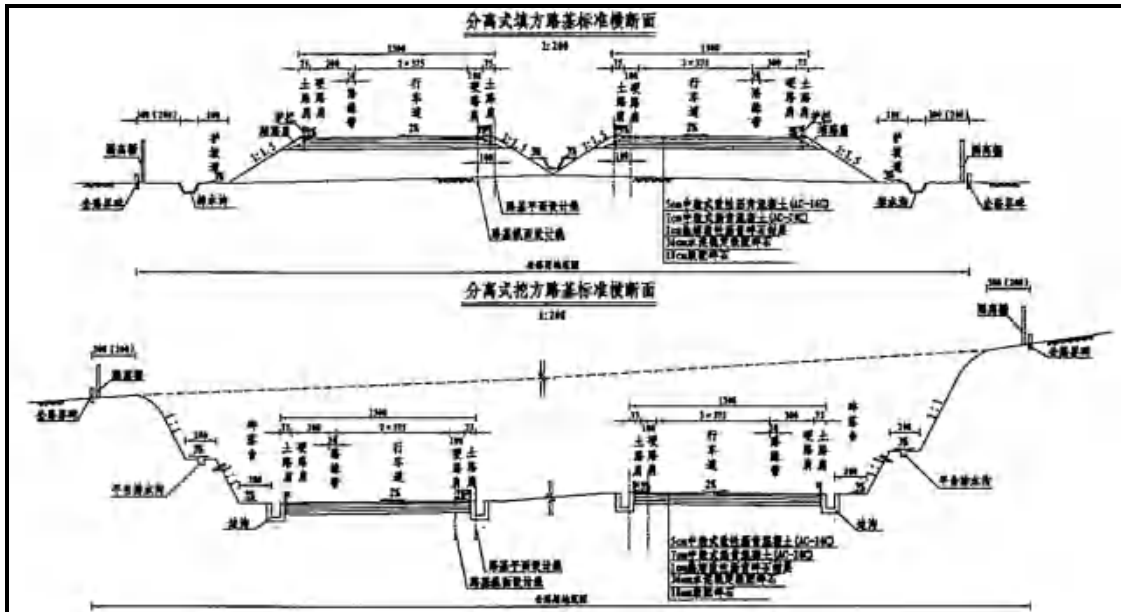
(1) 分离式路基标准横断面图 (分离式 13m)
